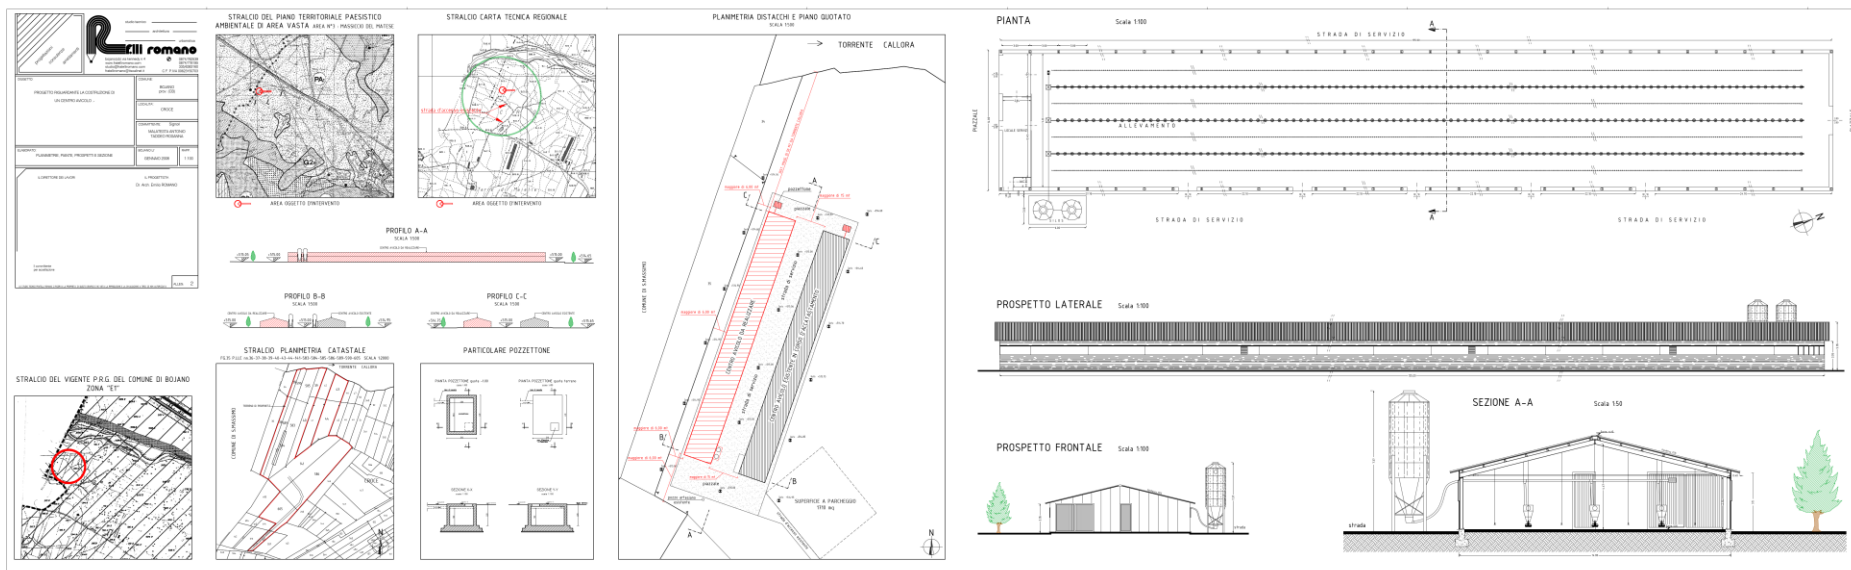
planimetria generale di stabilimento: Capannone D (da realizzare)
